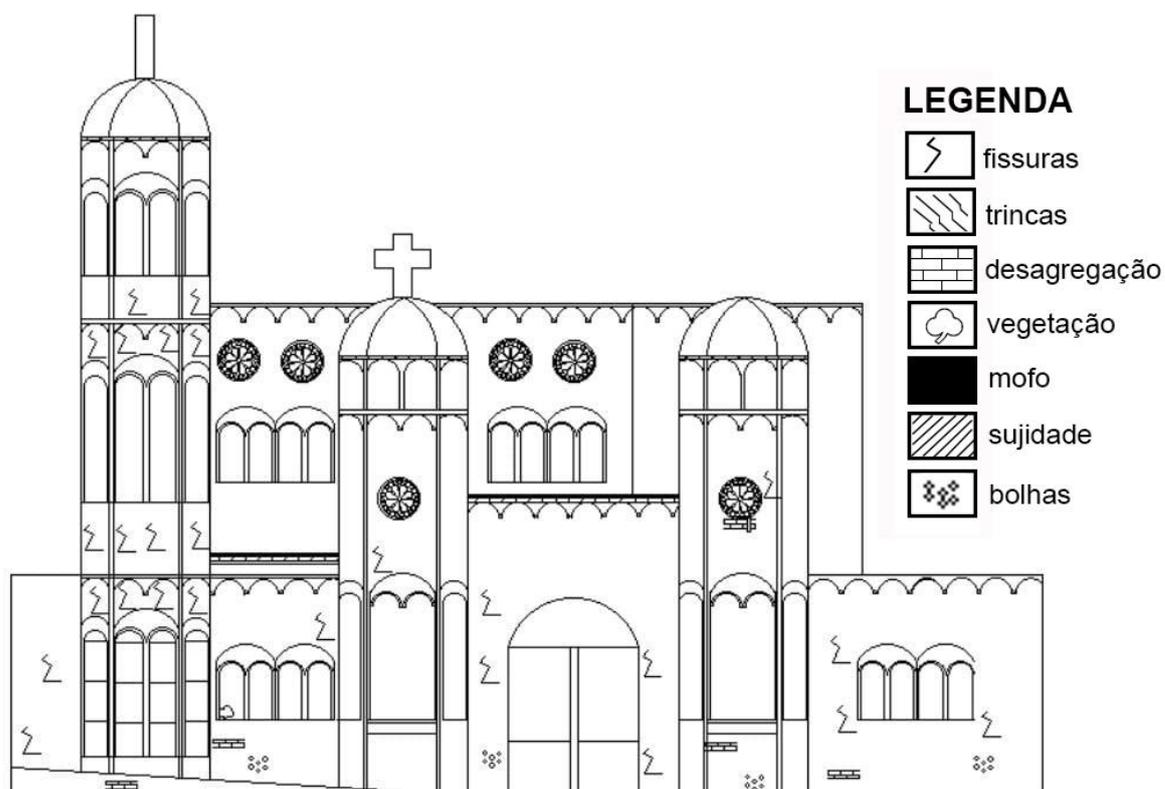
Fachada Noroeste da edificação: fissuras, desagregação, mofo e bolor.
